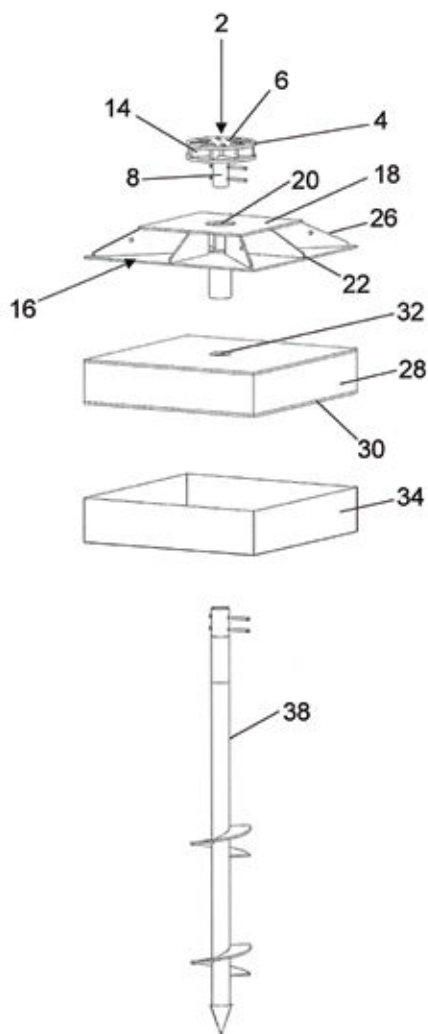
Vista tridimensionale della fondazione mista Geosmart
